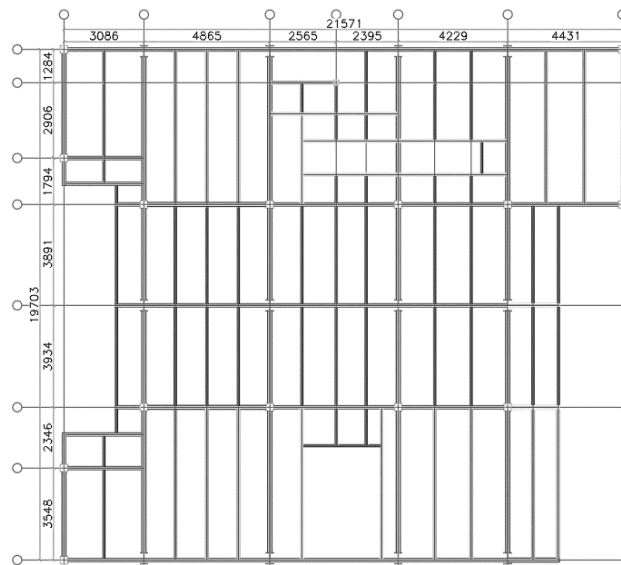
Vista en planta edificio de 3 pisos (piso 1).
